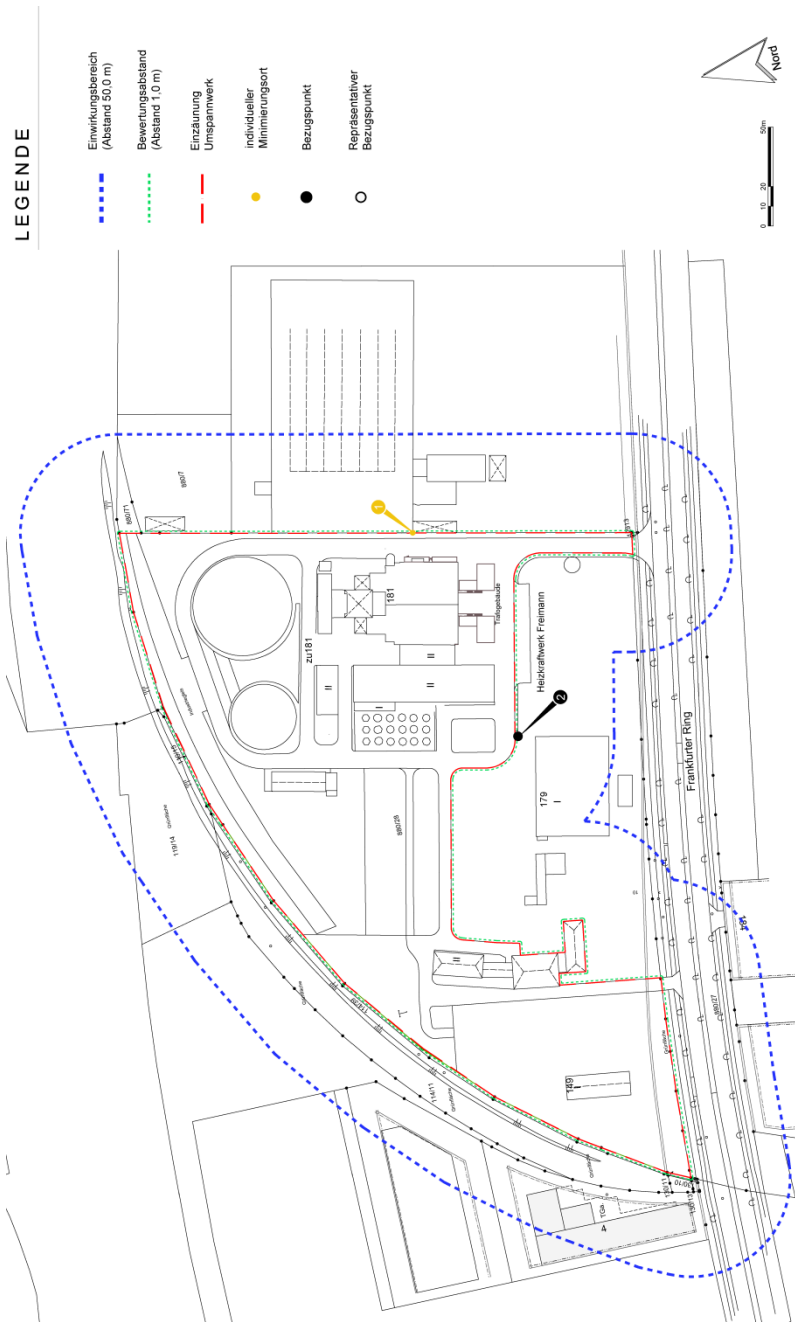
Lageplan des Heizkraftwerks mit eingezeichneten maßgeblichen Minimierungsorten (Beschreibung dazu siehe Tabelle 2).
